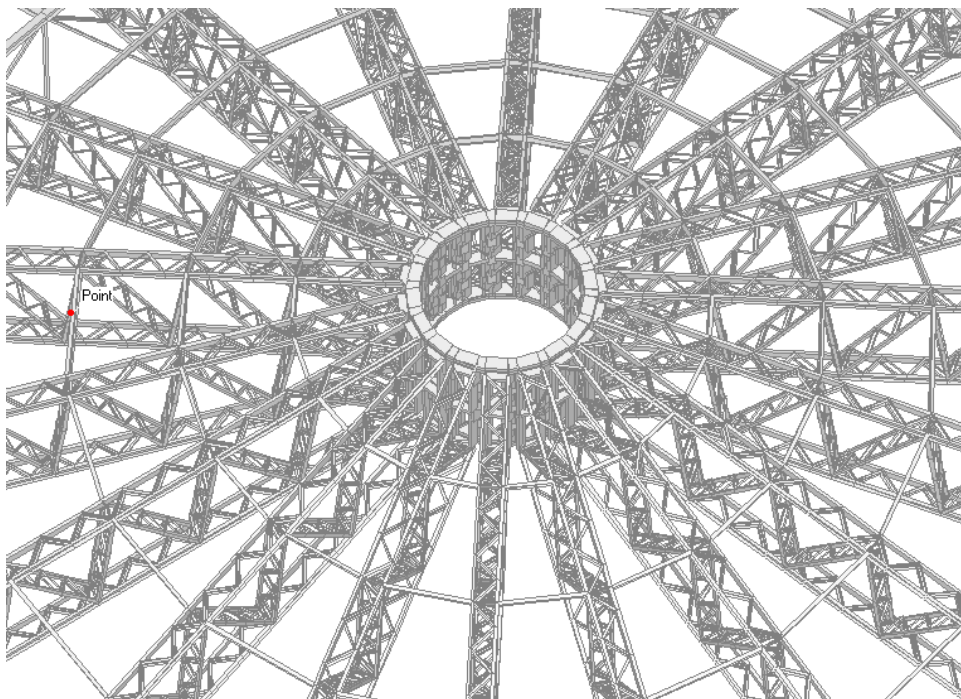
Pormenor – Ligação Arcos Meridianos - Anel de Fecho.
